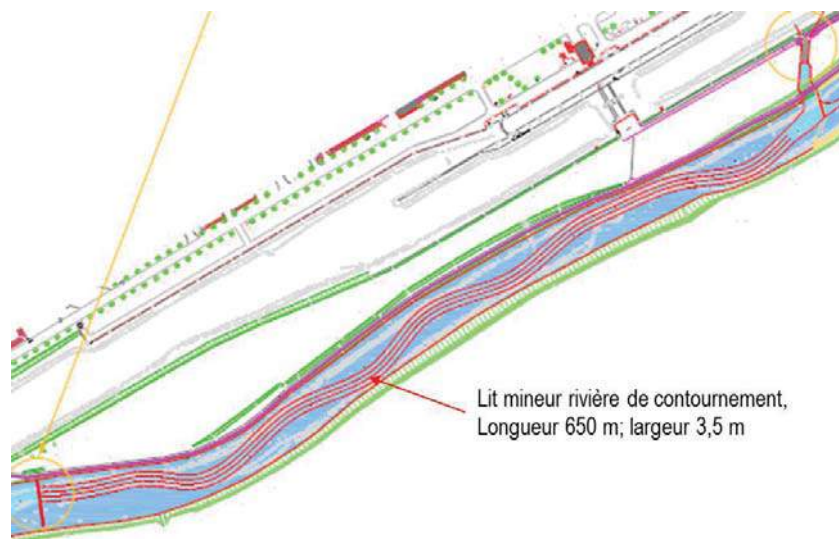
Plan de masse de reprofilage du délaissé de Comines
